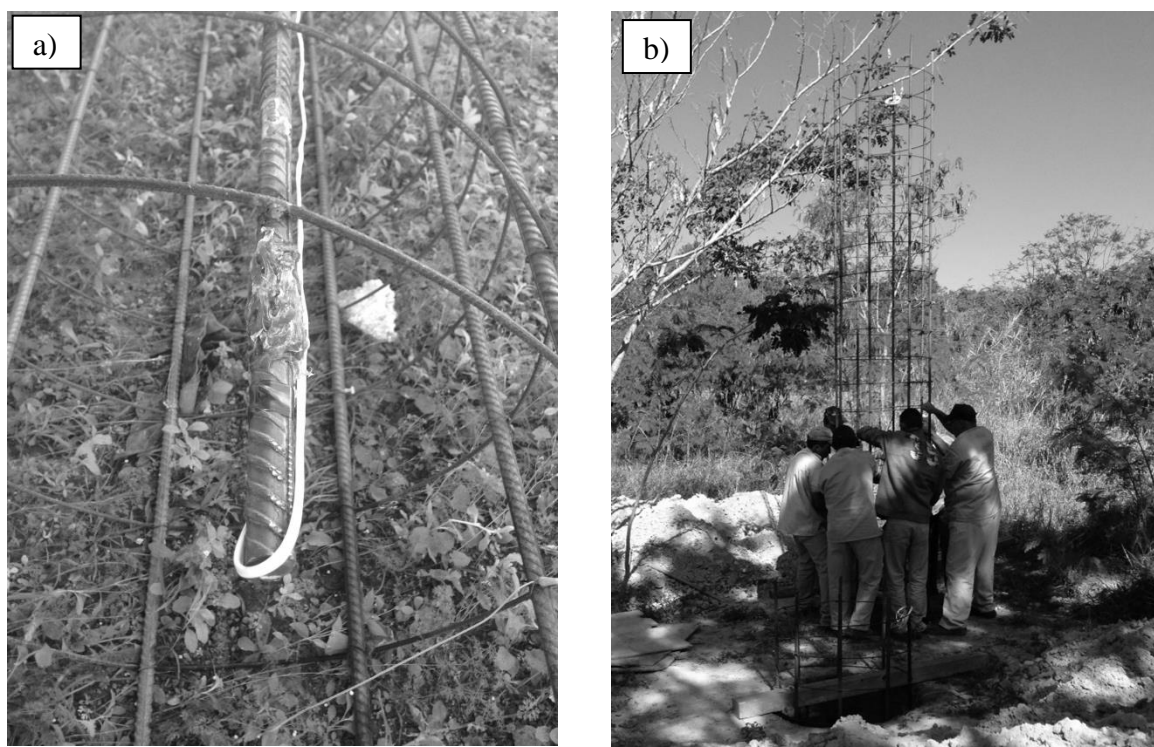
Instalação das barras instrumentadas na armadura dos tubulões e descida.
